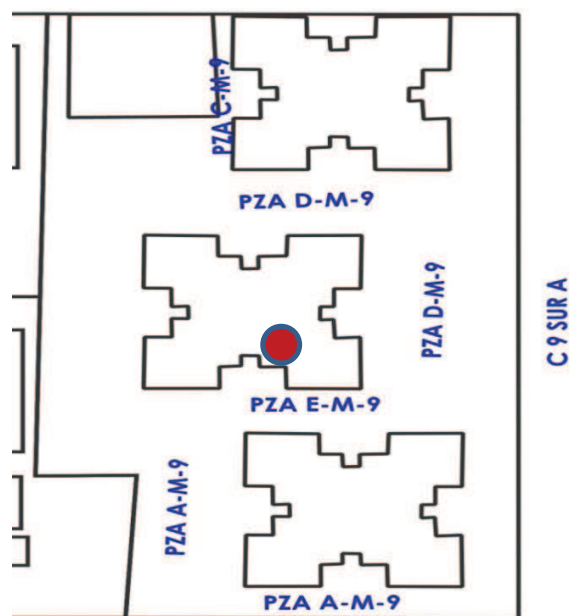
Plano de conjuntos de viviendas 1. Por: VRA, 2014
